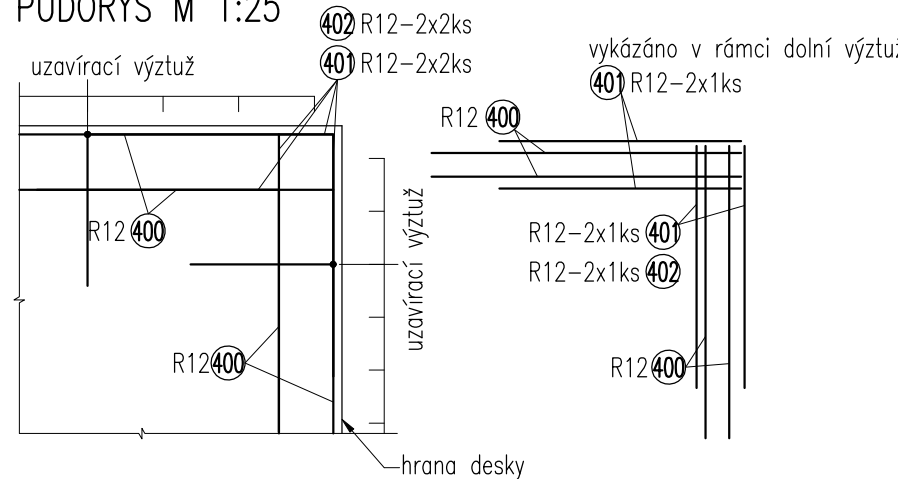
UKONČENÍ VĚNCE V1 PŮDORYS M 1:25
